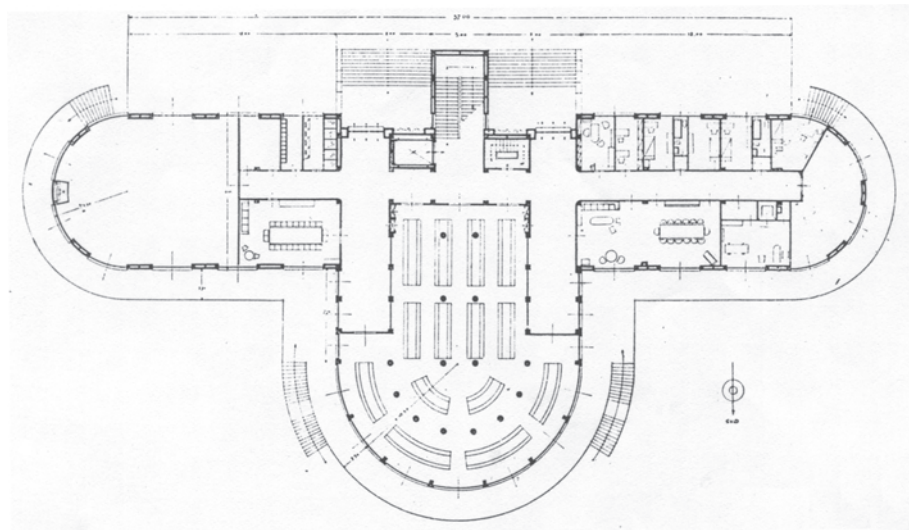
PNF-Ferienkolonie, Chiavari: Grundriss EG
